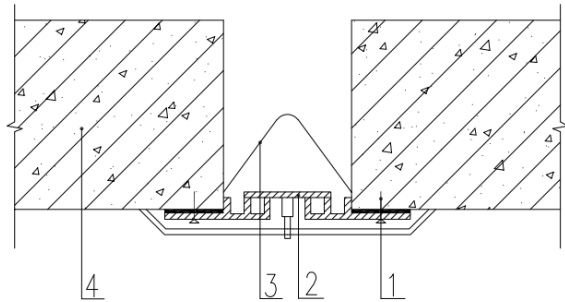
预制混凝土外墙变形缝密封防水设计
